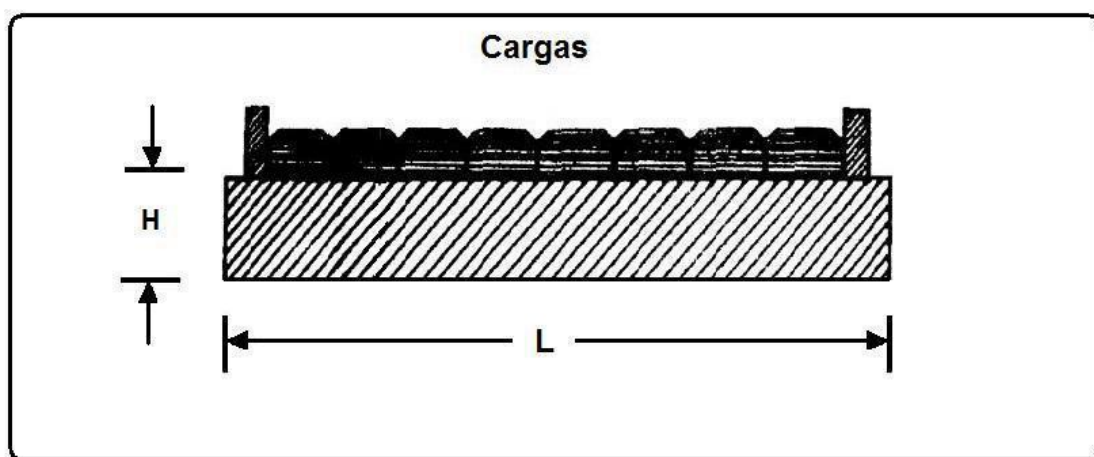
Perfil Transversal da ponte de laje de concreto
